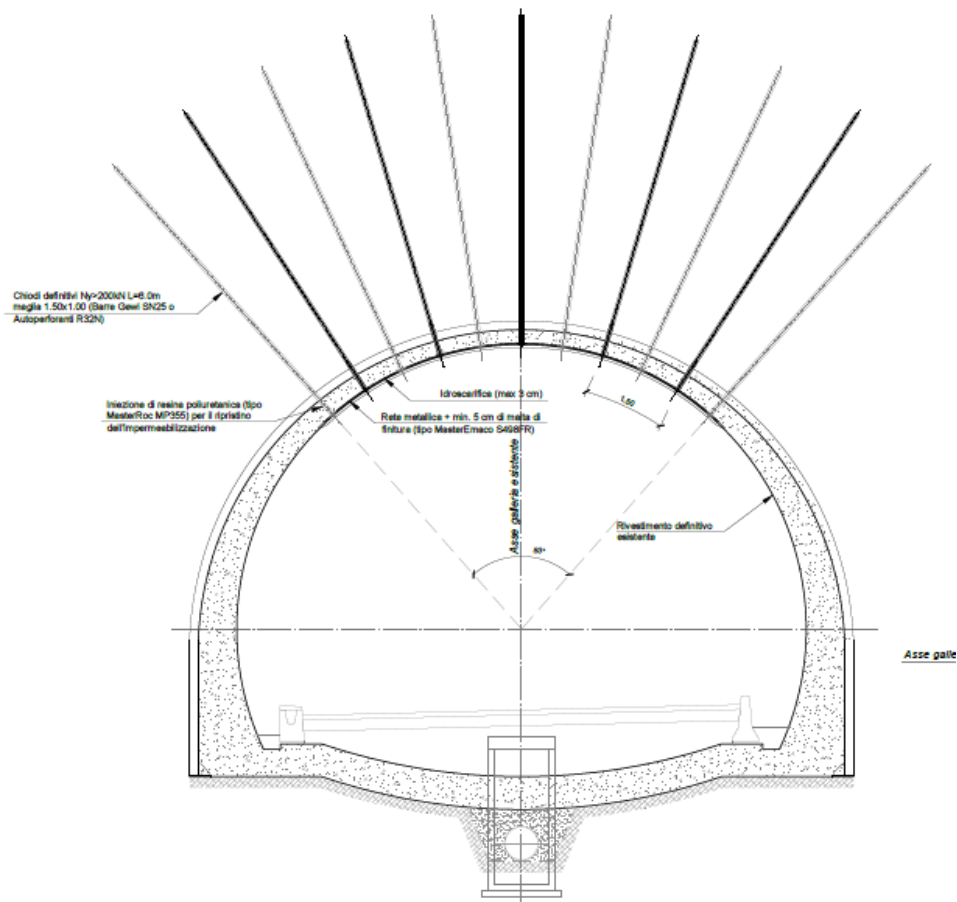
Galleria Guinza – Intervento Tipo A – Sezione corrente – Carpenteria
